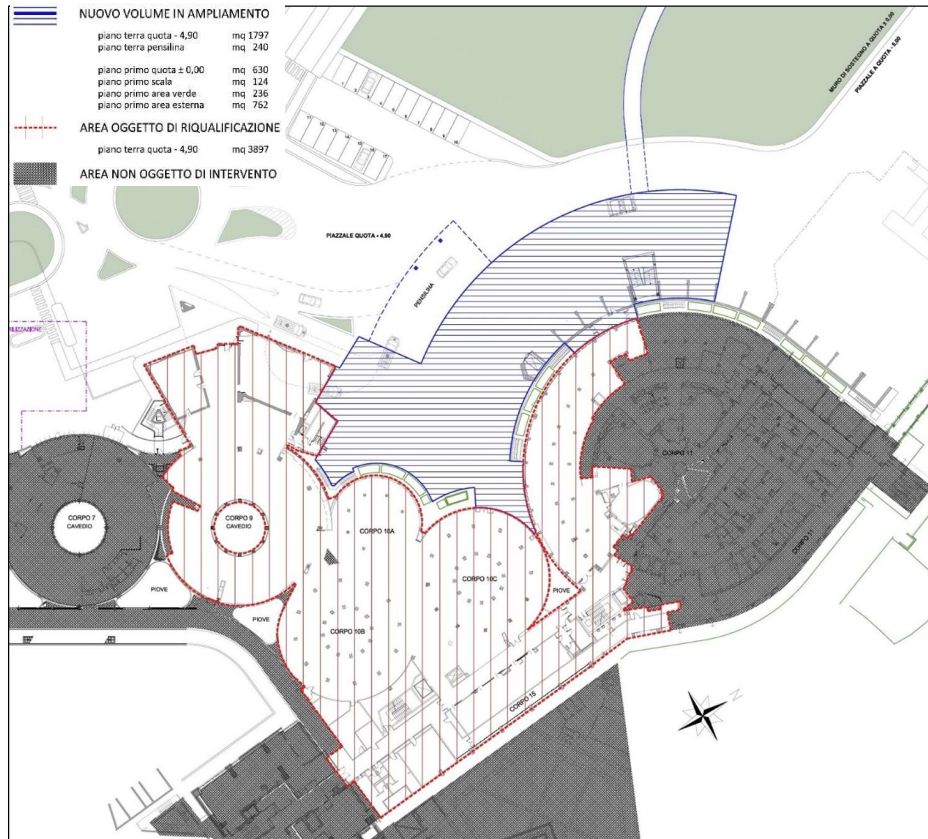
Individuazione aree di progetto (Stralcio DIP)
